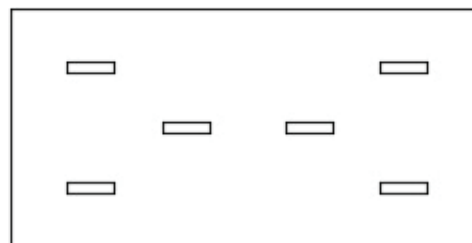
Schema planimetrico. Fonte: Elaborazione dell'autore
